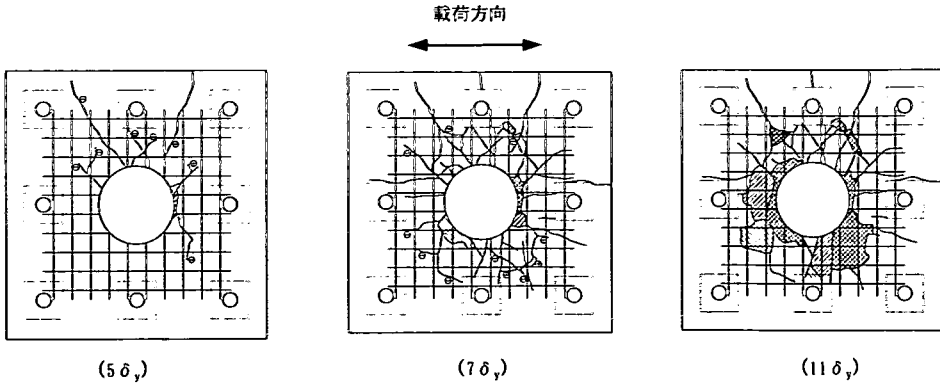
フーチング上面コンクリートのひび割れ進展状況 (JTSC-9)
